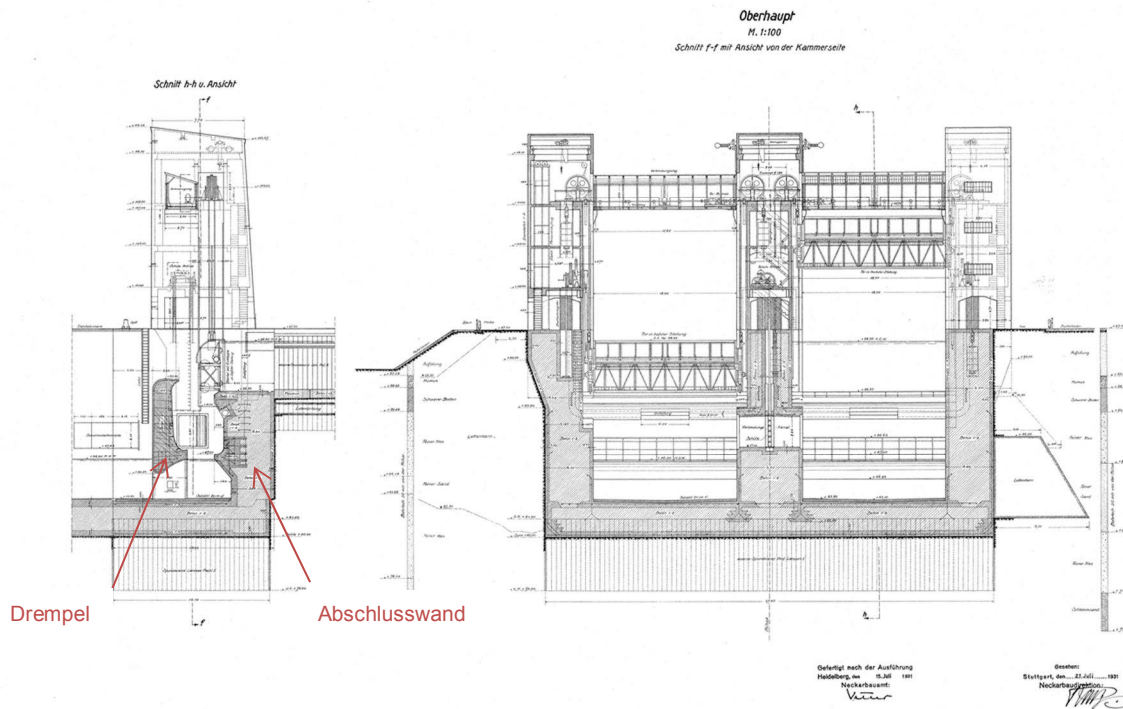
Längs- und Querschnitt des bestehenden Oberhauts
